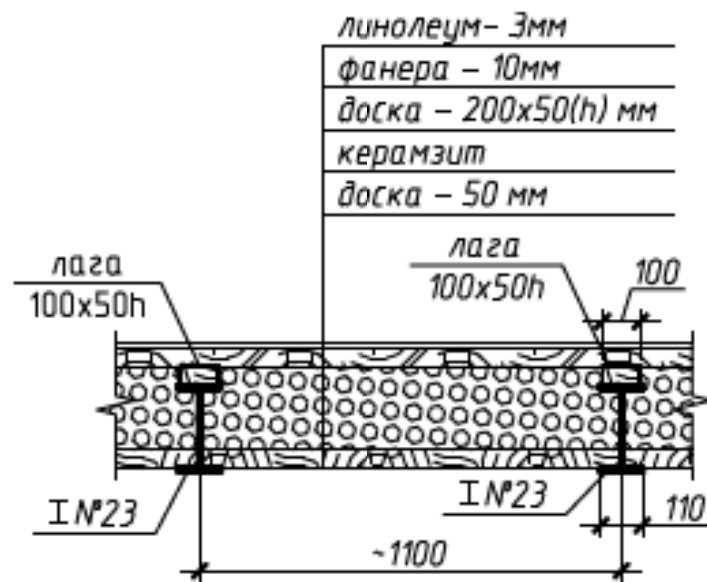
Вскрытие 5 (пол 3-й этаж)
